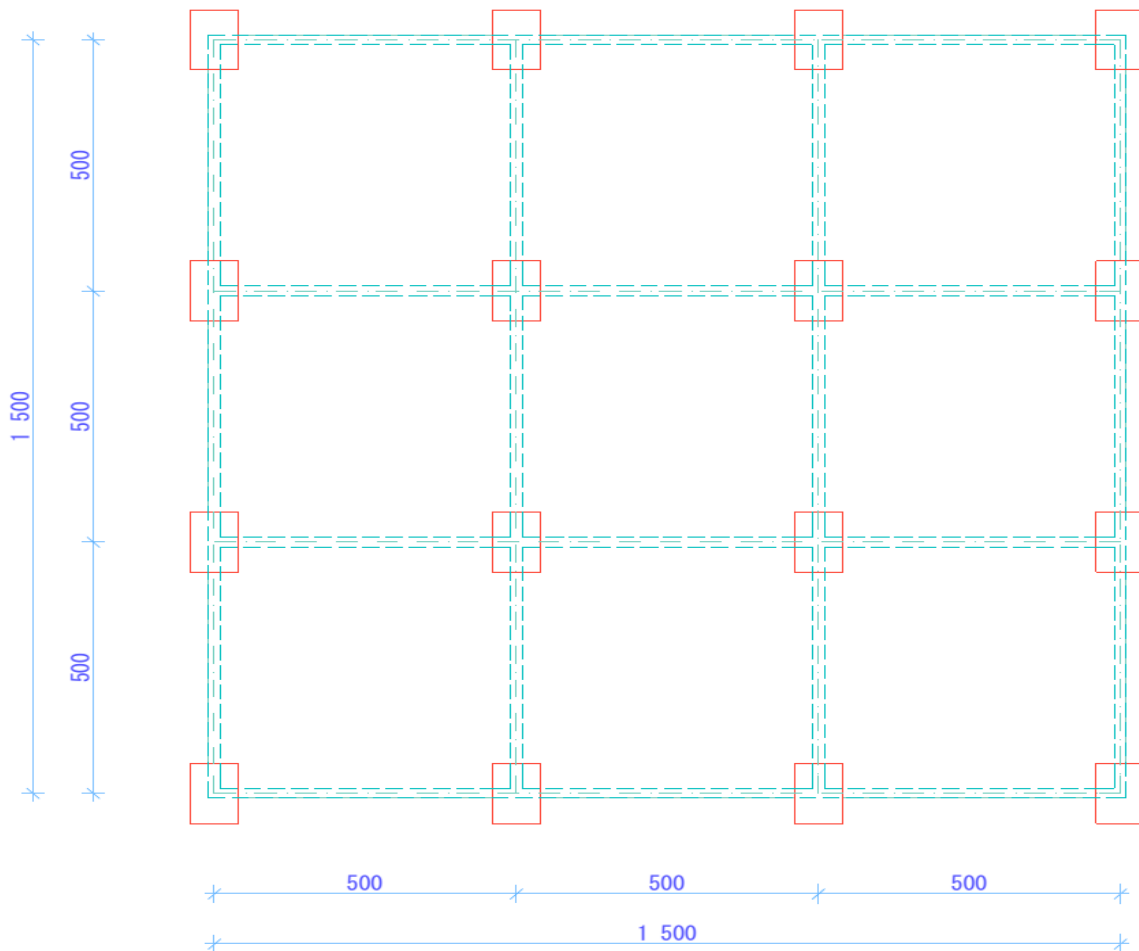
Vue en plan de la structure (l'unité en centimètre)
